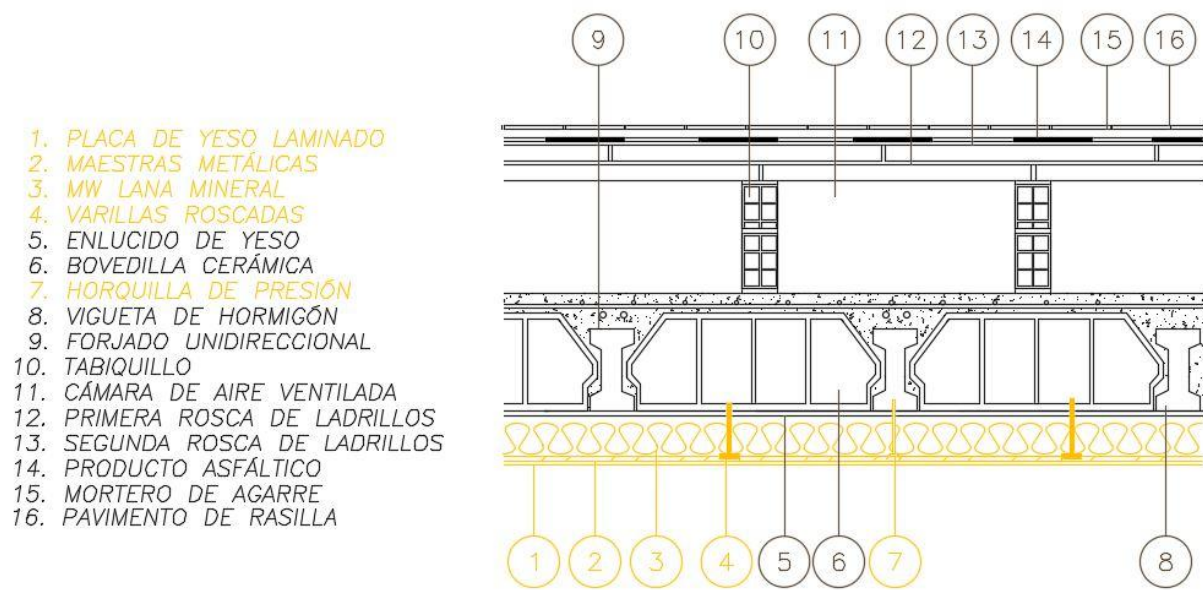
Detalle constructivo de la cubierta rehabilitada. Fuente: Elaboración propia
